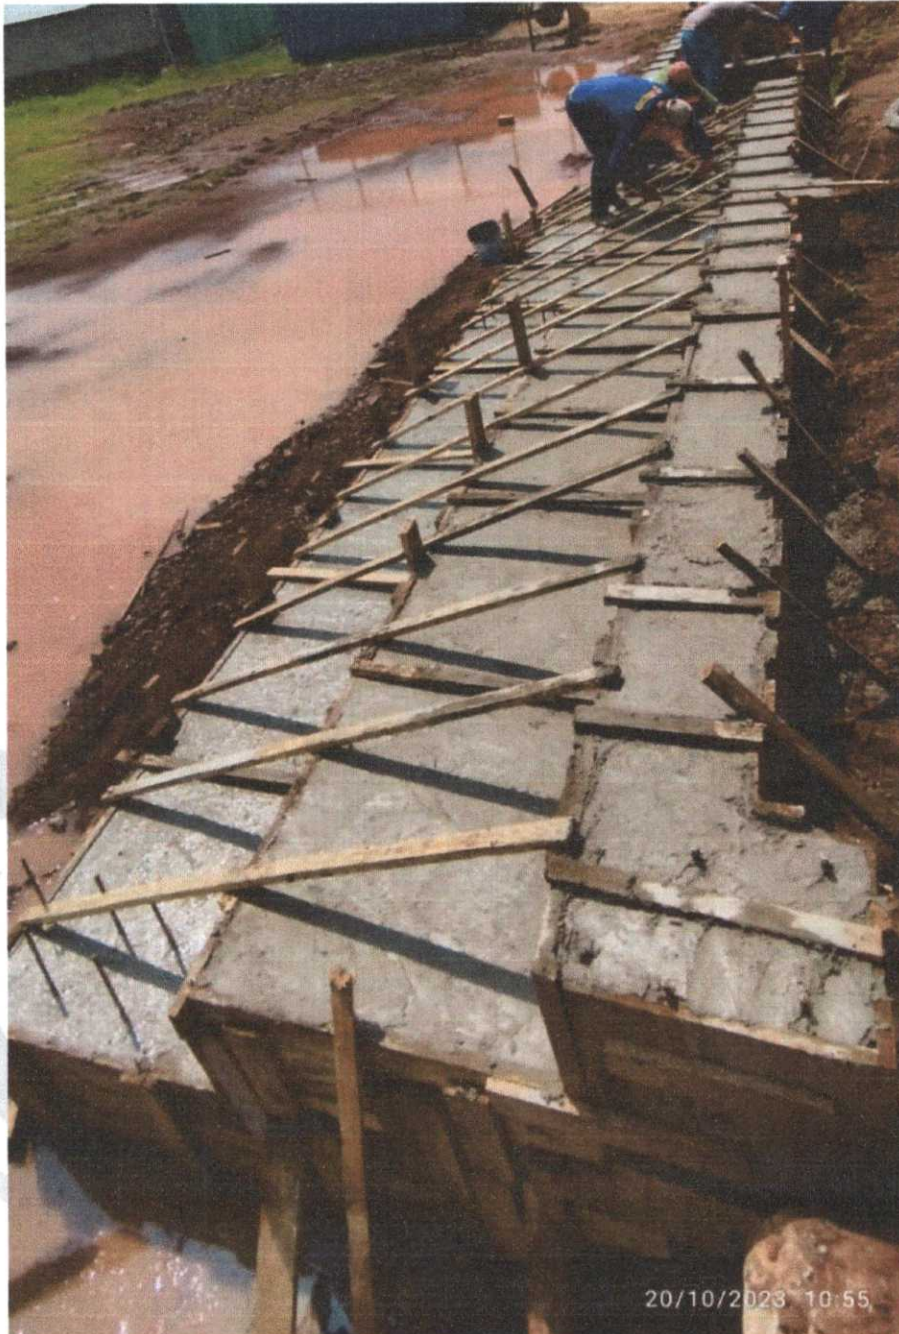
/10/23, após a concretagem das arquibancadas, com a canteiro de obra alagado.
